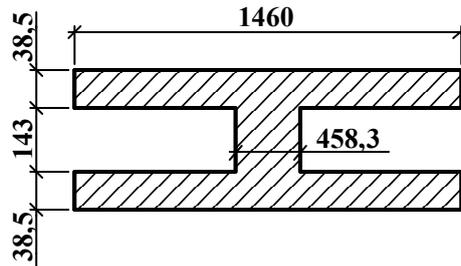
Поперечное сечение многопустотной плиты
